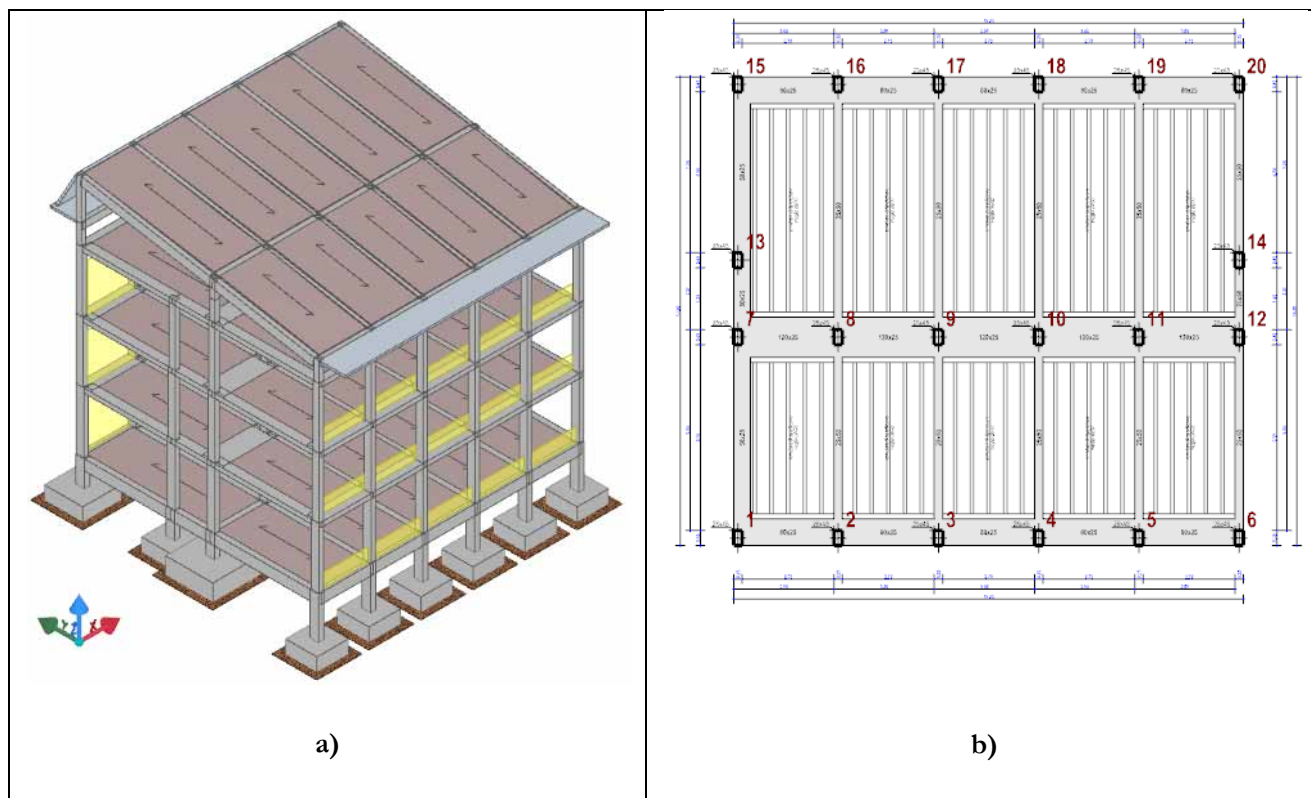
Intervento di miglioramento: a) Vista 3D; b) Carpenteria piano terra
